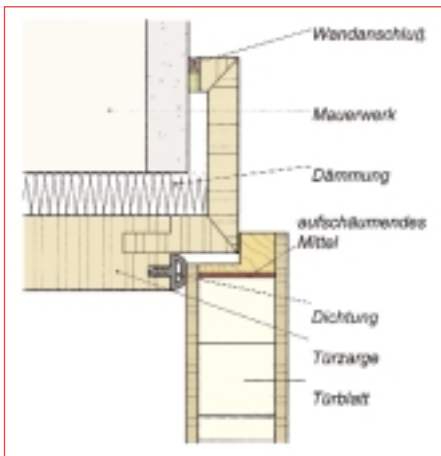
T 30-1-Tür aus Holz und Holzwerkstoffen
